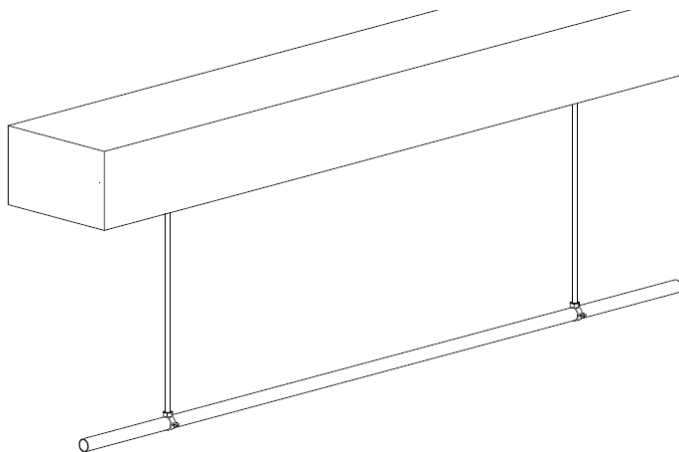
Подвес кабеля в стальной трубе на шпильке
